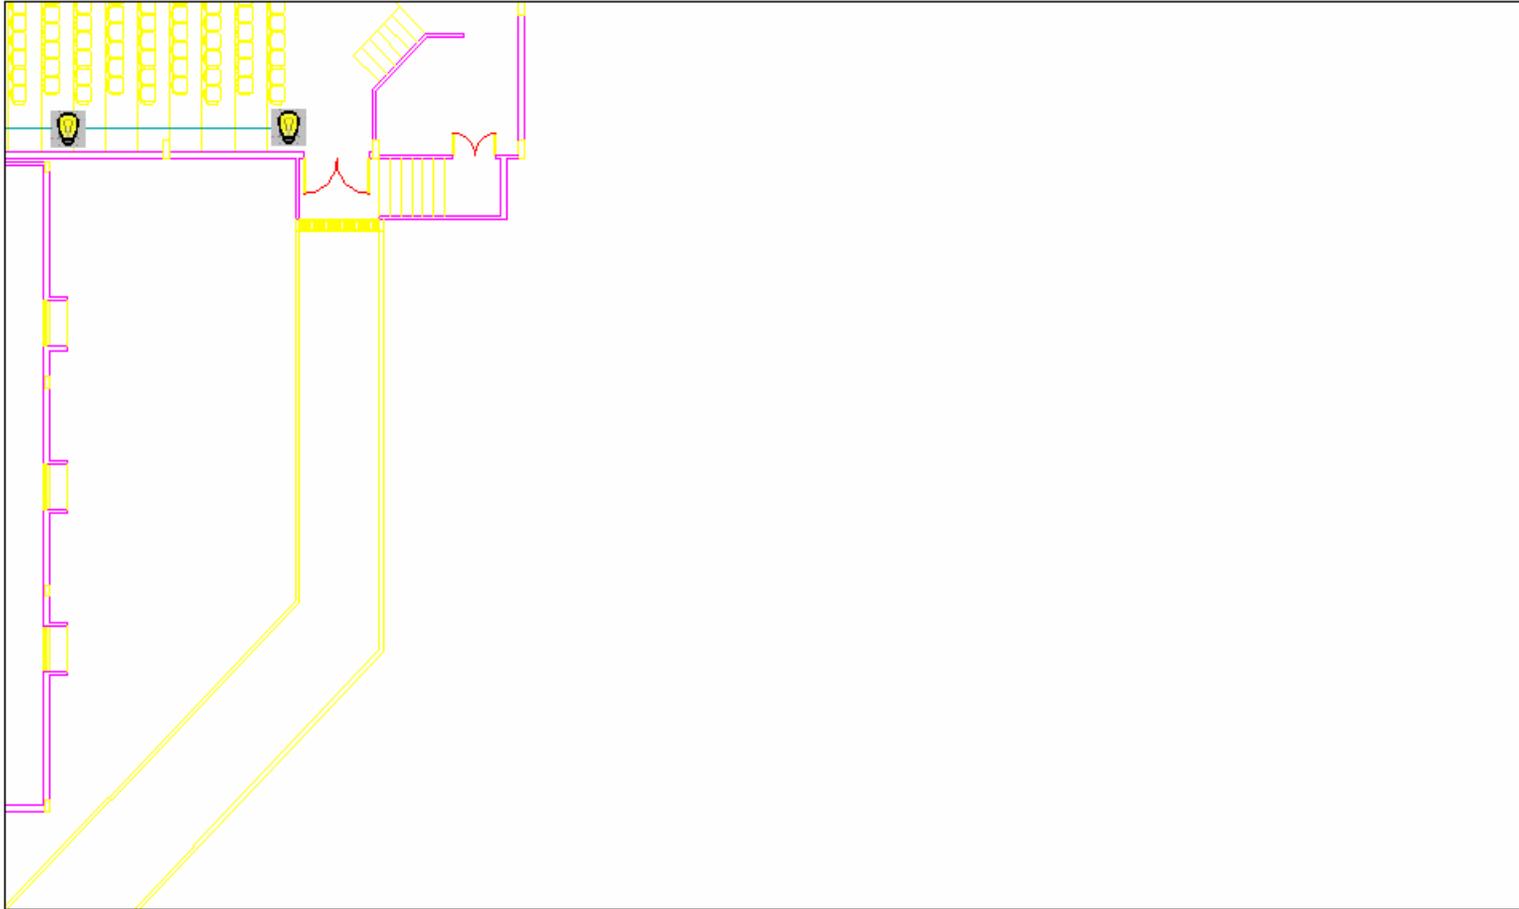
PLANO ILUMINACION PLANTA BAJA SECCION 3
